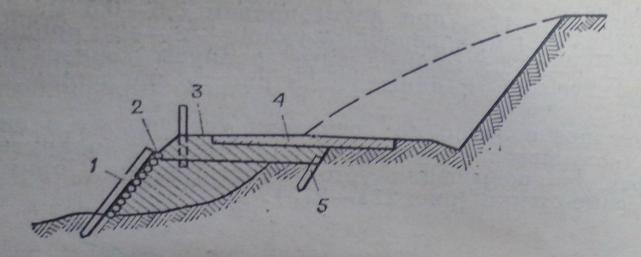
Поперечный профиль дороги на косогоре с заборной стенкой из дерева: 1—свайная опора; 2—заборная стенка; 3—насыпь; 4—дорожная одежда; 5—анкер с растяжкой
